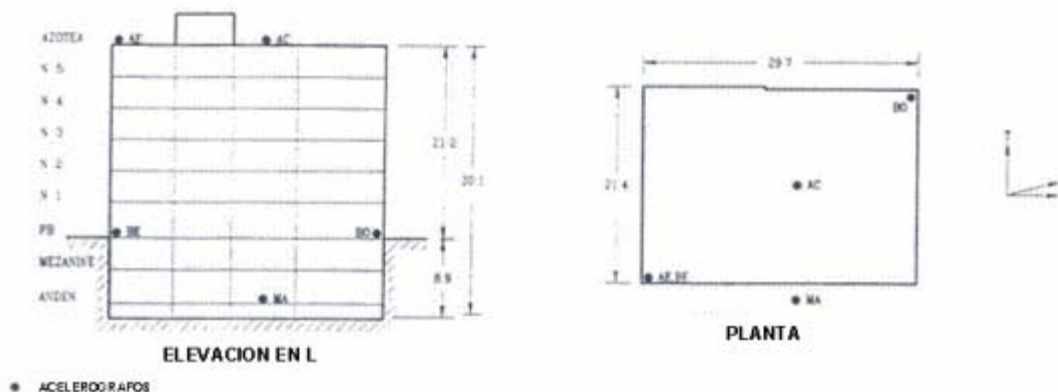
Vista esquemática (planta y elevación) del edificio instrumentado MJ
